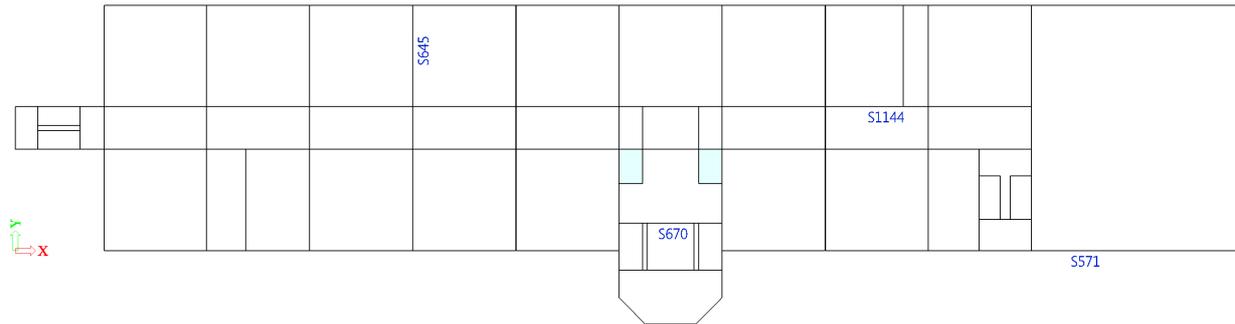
Grundriss - Position maßgebende Rippen
